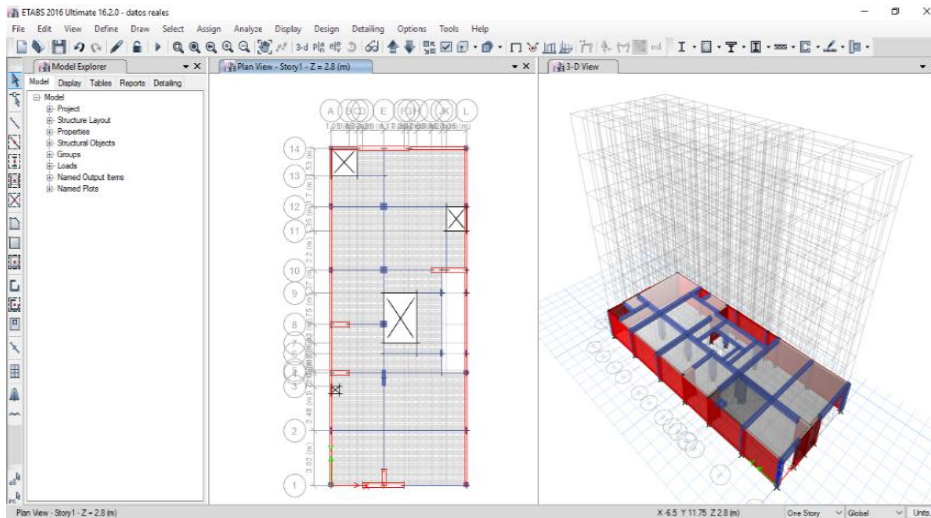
Asignación de secciones de vigas, columnas, muros y losas (ETABS 2016).
